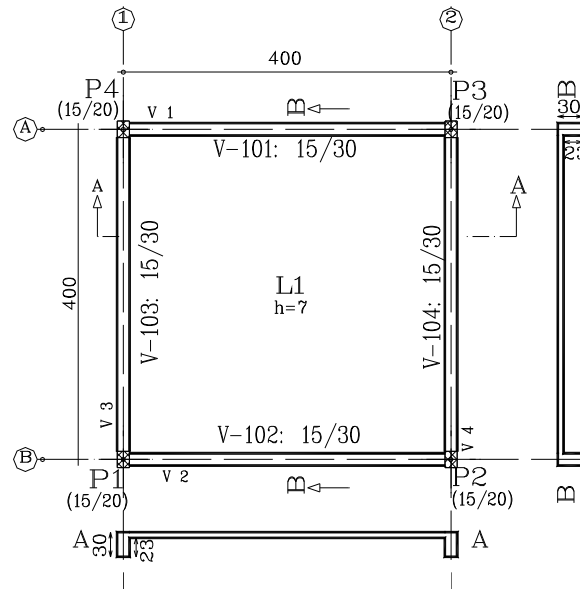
Planta de forma de laje maciça com vigas de bordo
